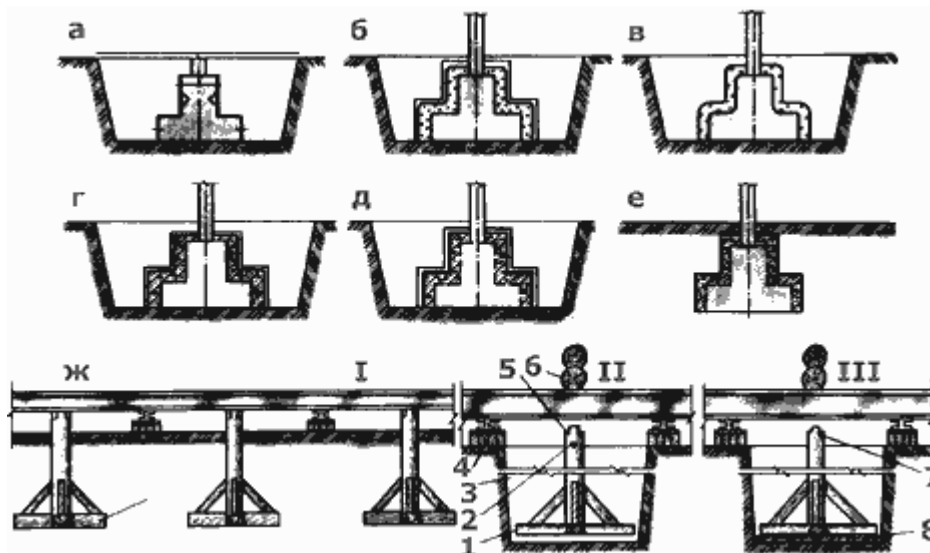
Усиление и замена фундаментов: а - устройство анкеров и шпонок в фундаменте; б - установка арматурной сетки и крепление ее к выпущенным анкерам; в - установка опалубки вокруг фундамента, подлежащего усилению; г - бетонирование дополнительных участков фундамента; д - снятие опалубки и устройство гидроизоляции фундамента; е - засыпка котлована и трамбование грунта; ж - порядок ремонта деревянных столбчатых фундаментов; I - фундамент, требующий ремонта; II - открытие котлована; III - установка нового деревянного стула и обратная засыпка с последующим трамбованием; 1 - деревянные стулья; 2 - участки, подверженные загниванию; 3 - открытый котлован; 4 - домкрат; 5 - старый деревянный стул; 6 - обвязка; 7 - новый деревянный стул; 8 - грунт, тщательно утрамбованный щебнем.
